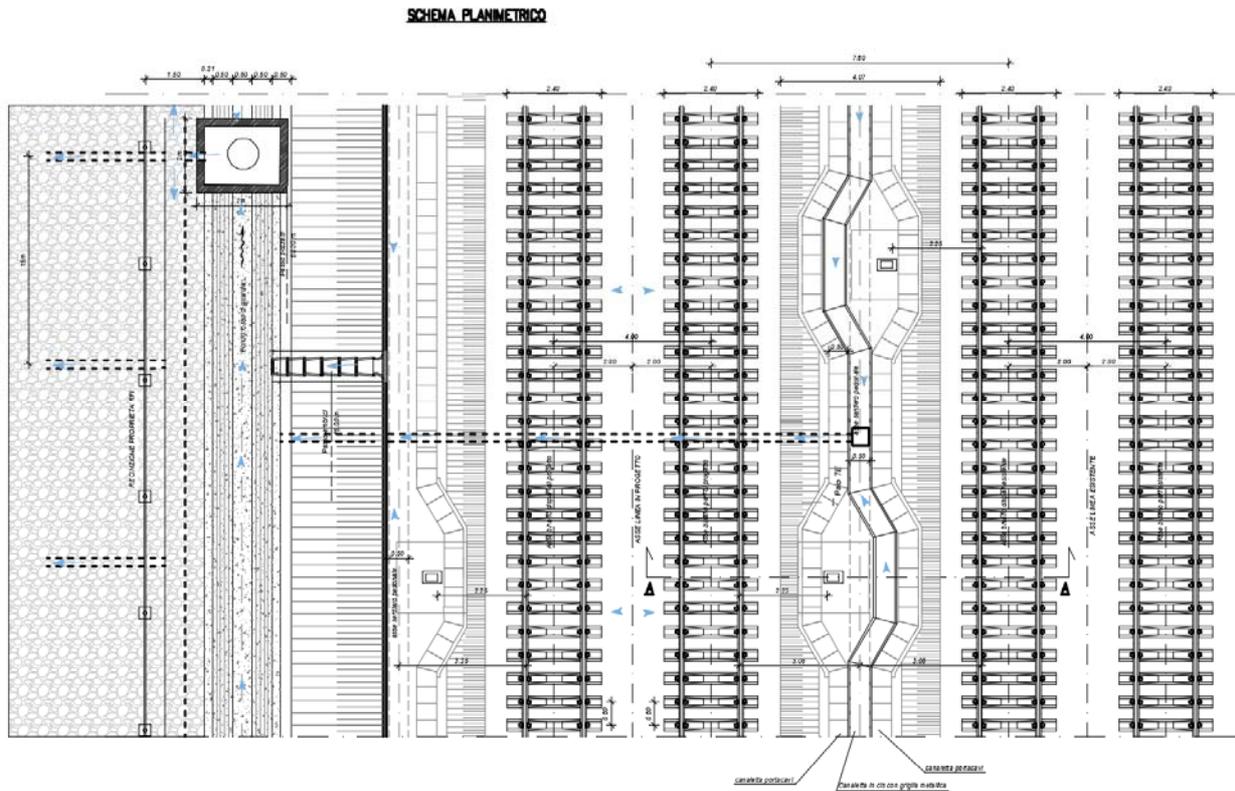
Schema planimetrico del sistema di recapito a dispersione con trincea drenante.
